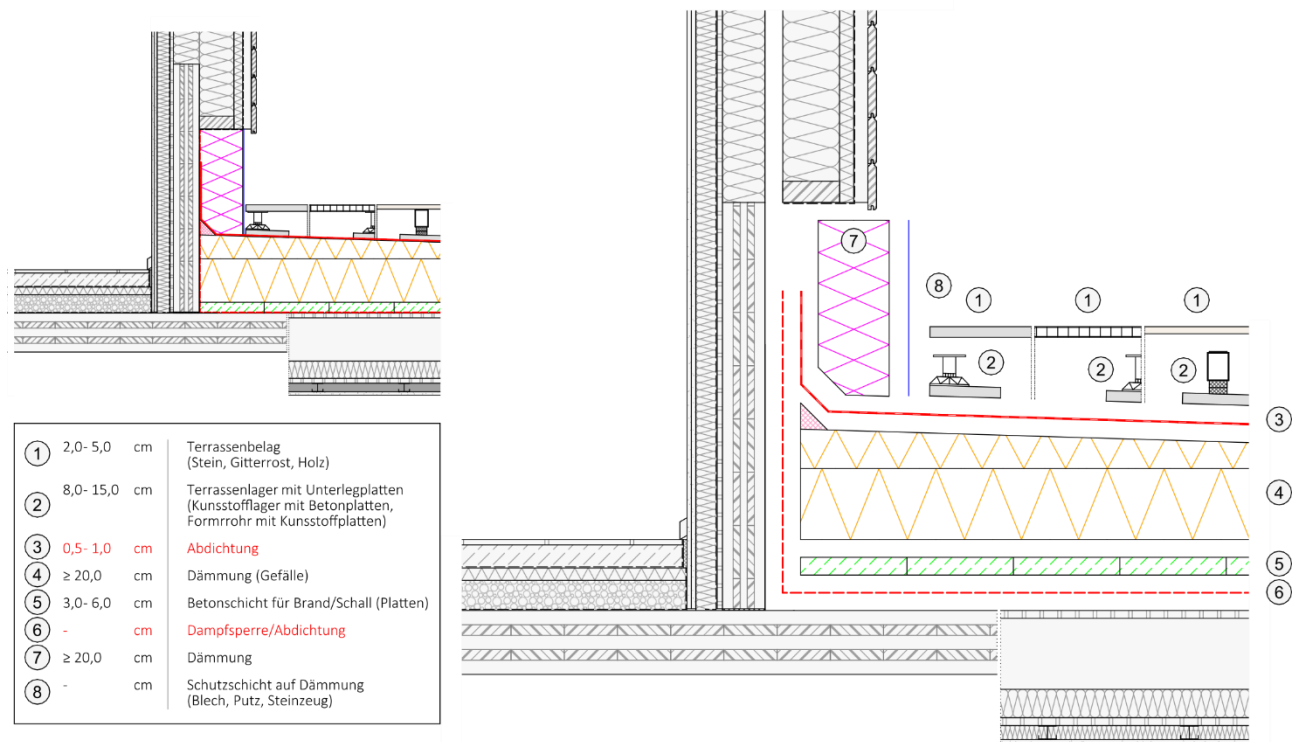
Detailausbildung – Holzrahmenbau mit Massivholzsockel auf Holzuntergrund
